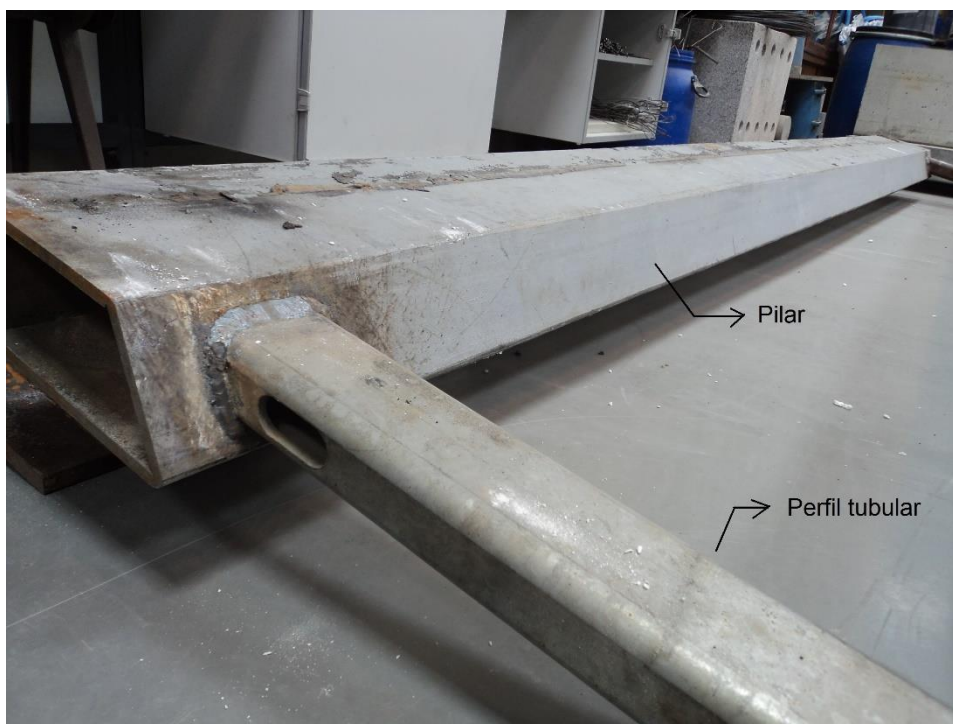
Estrutura metálica de suporte: pilar e perfil tubular
